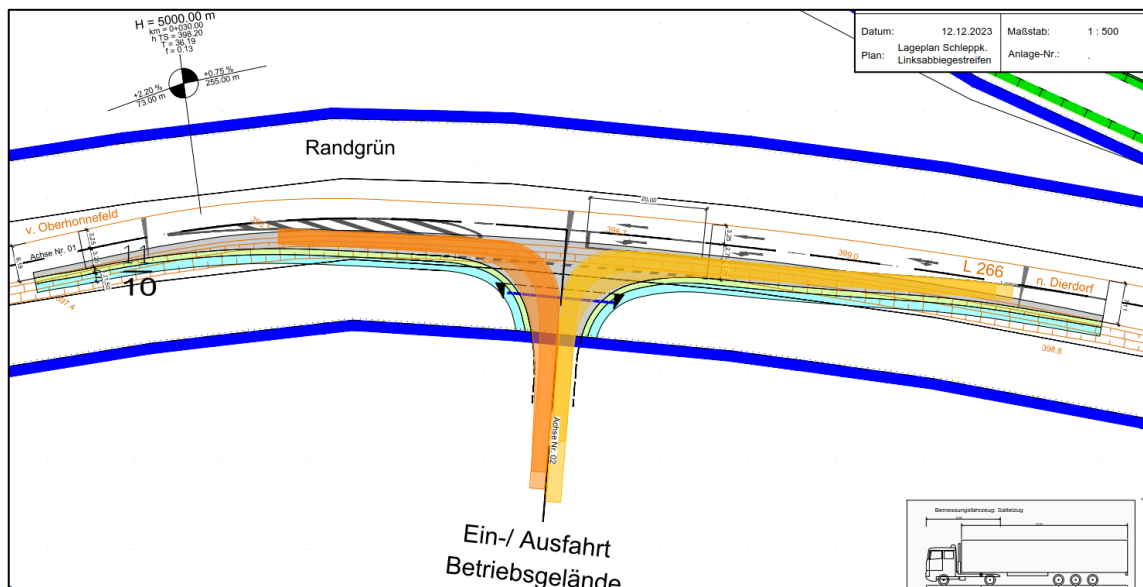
Auszug aus dem Lageplan / Schleppekurven (Planungsbüro Dittrich, 12.12.2023)
